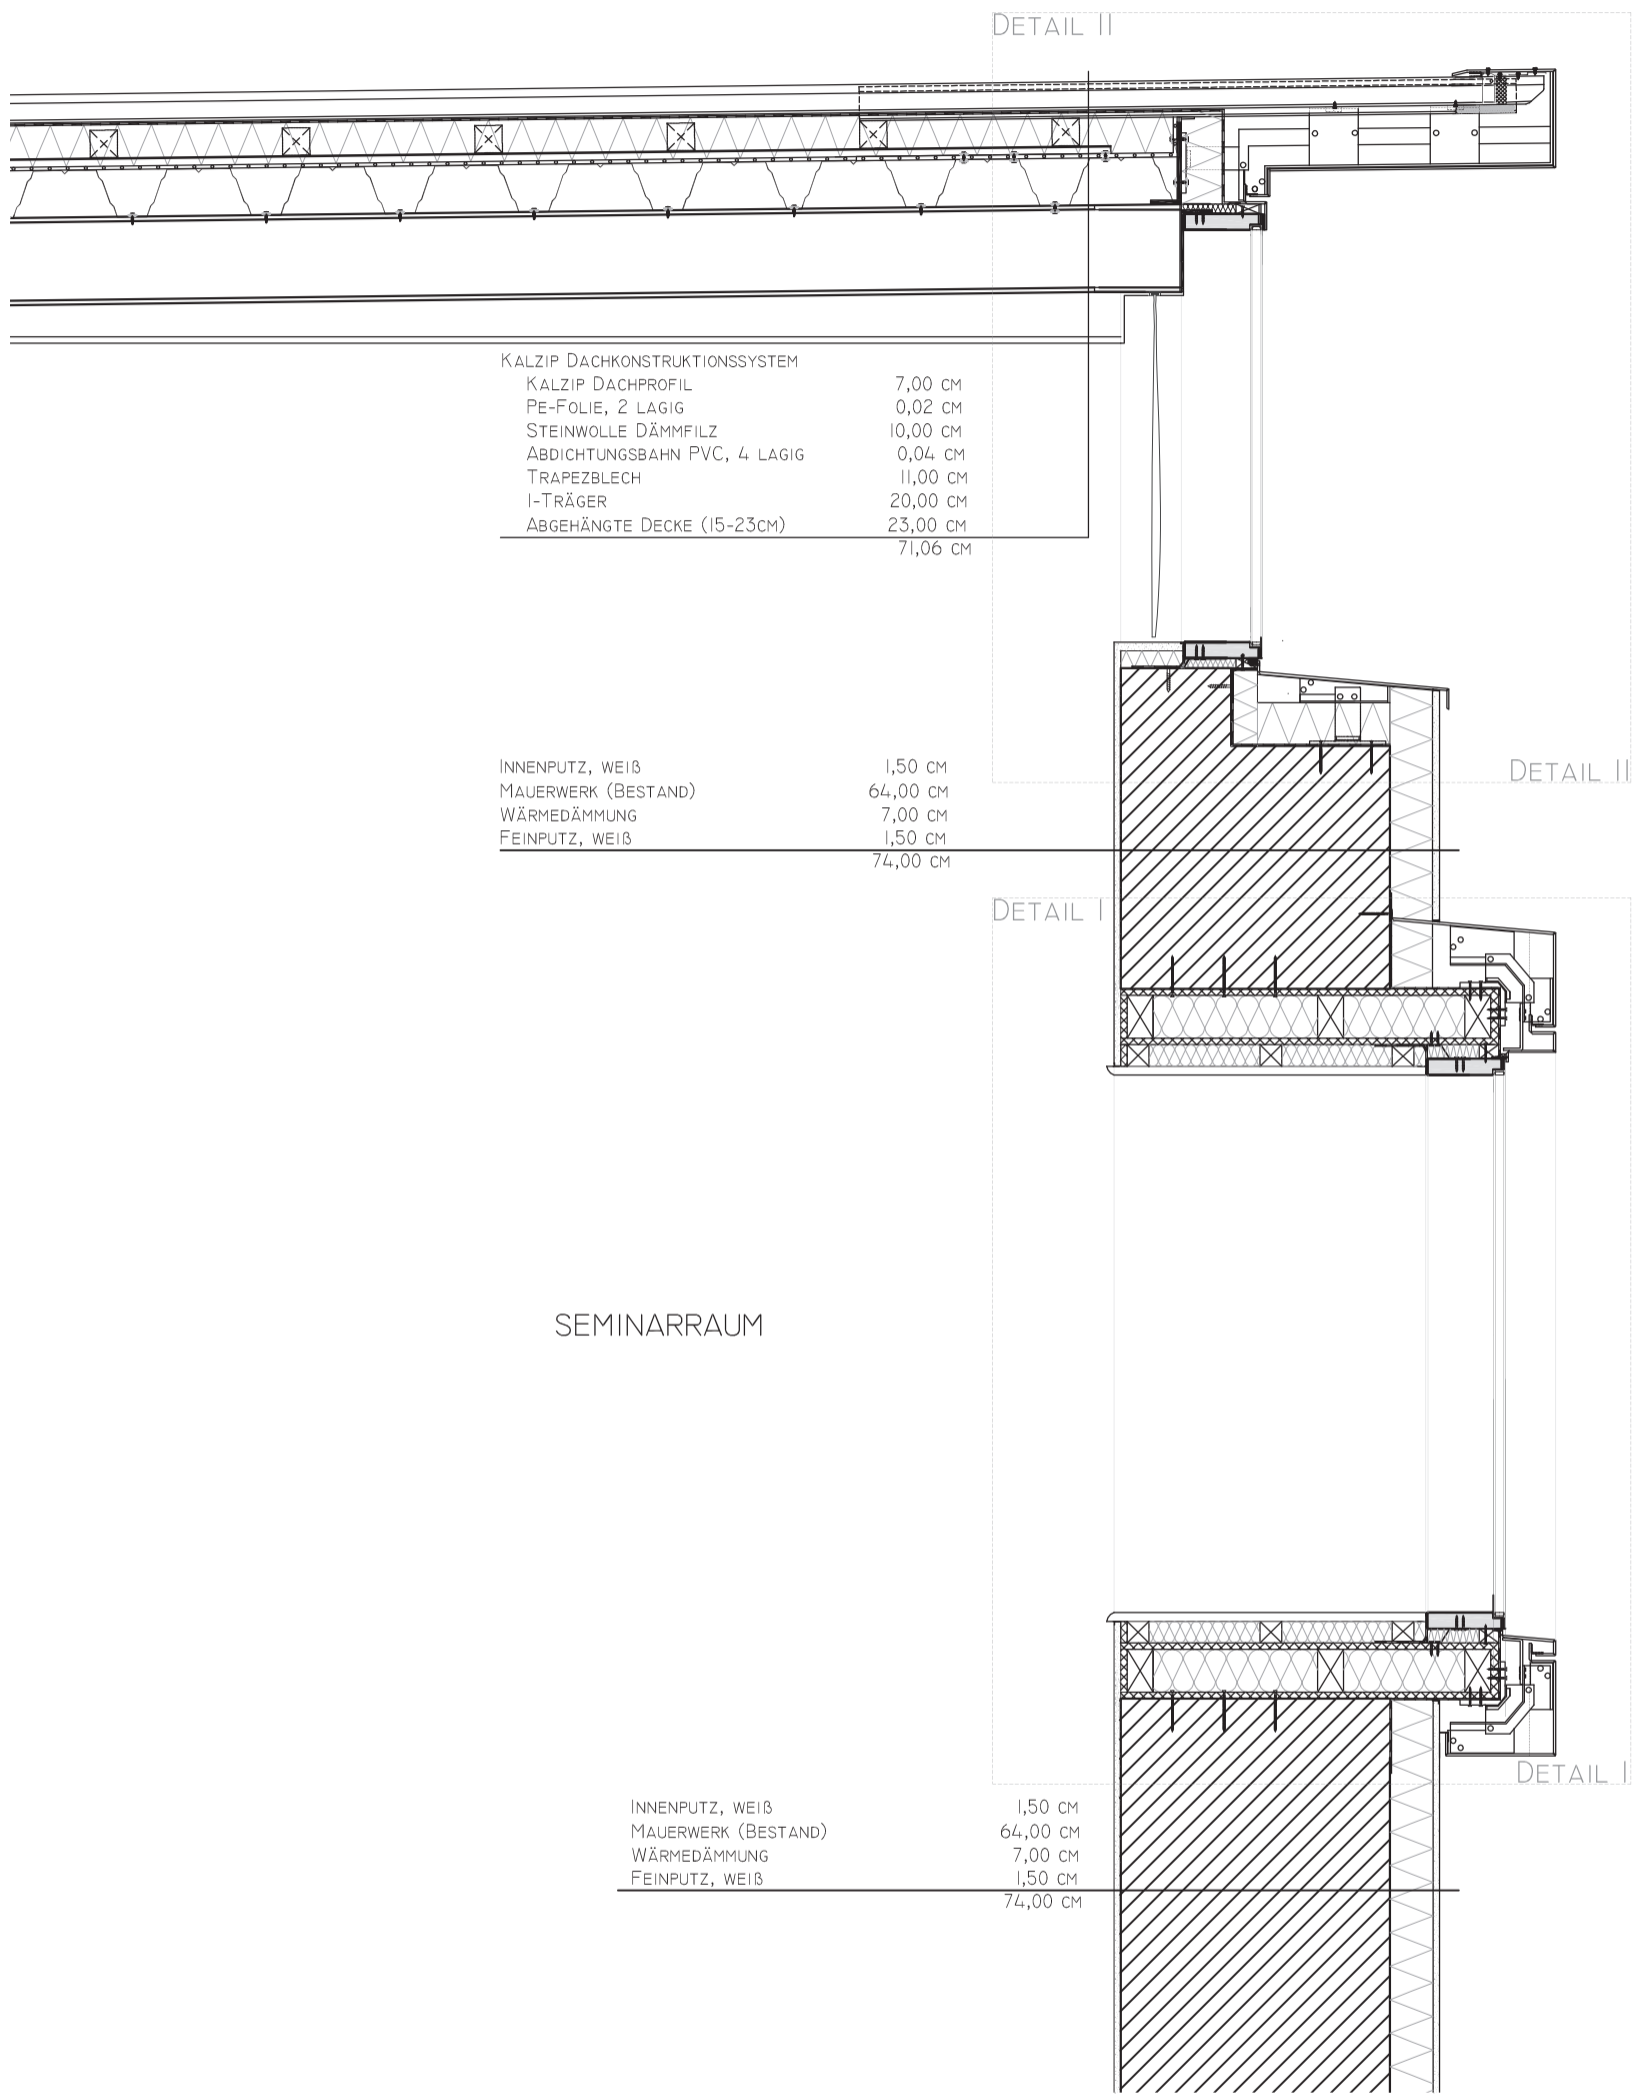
Schnitt Fassade oben, Dach, 1:20
